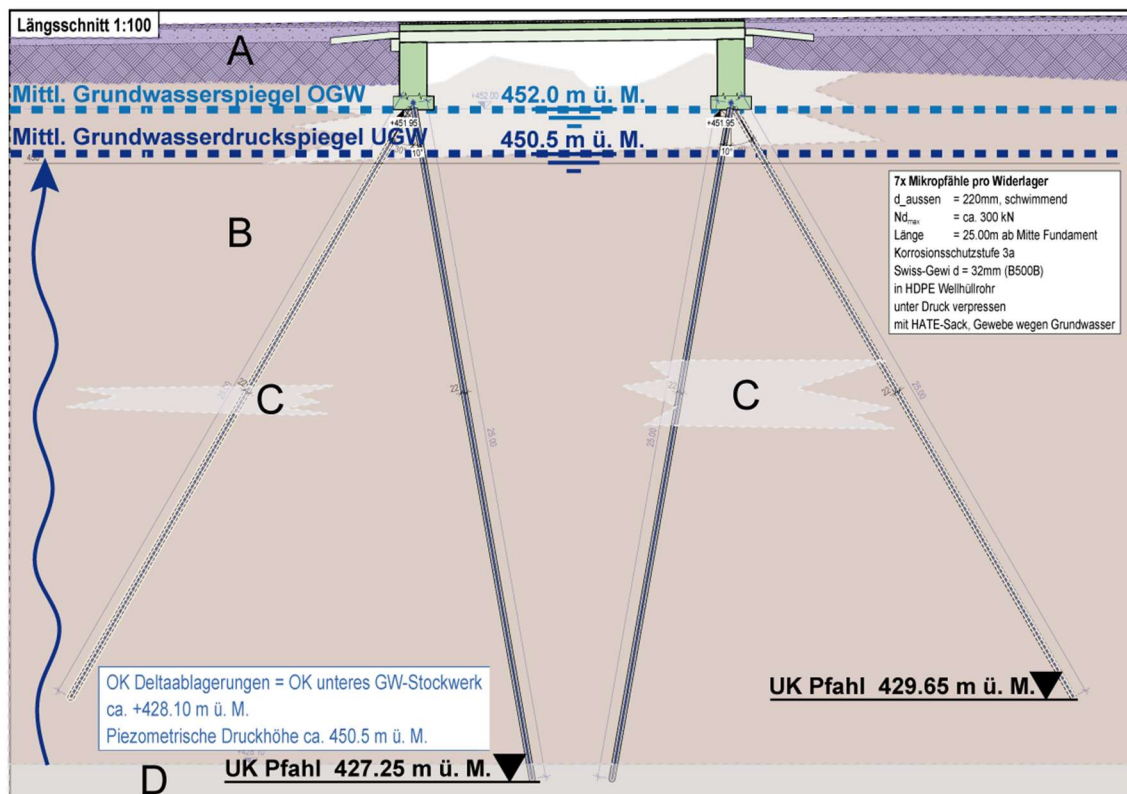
Längsschnitt mit der projektierten Pfahlfundament; Schichtaufbau gemäss Tabelle 1 [6].
